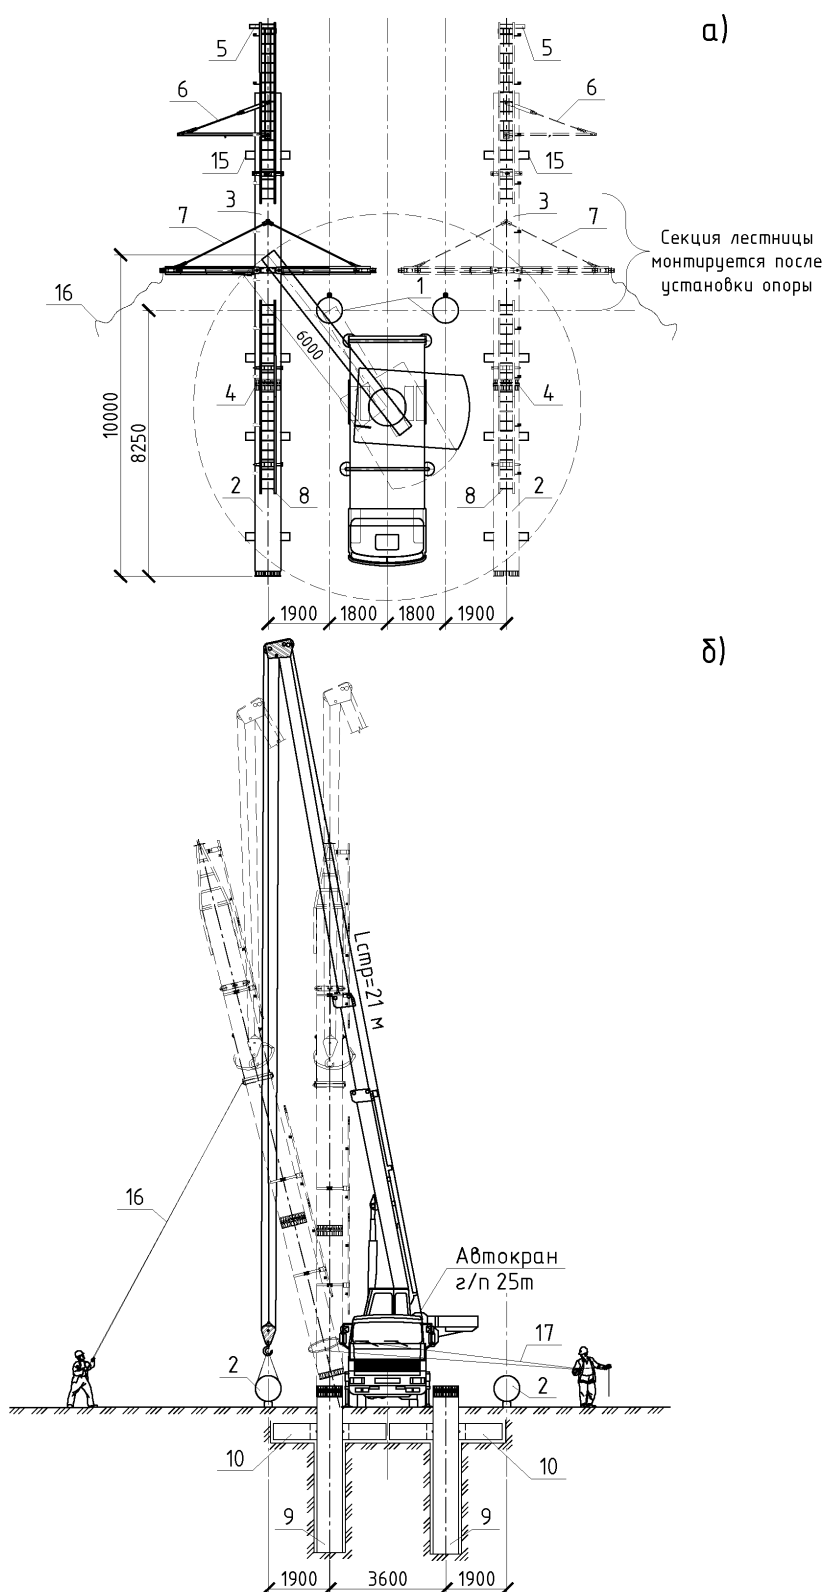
Схема сборки и монтажа опор 2СУБ110-1Ф
